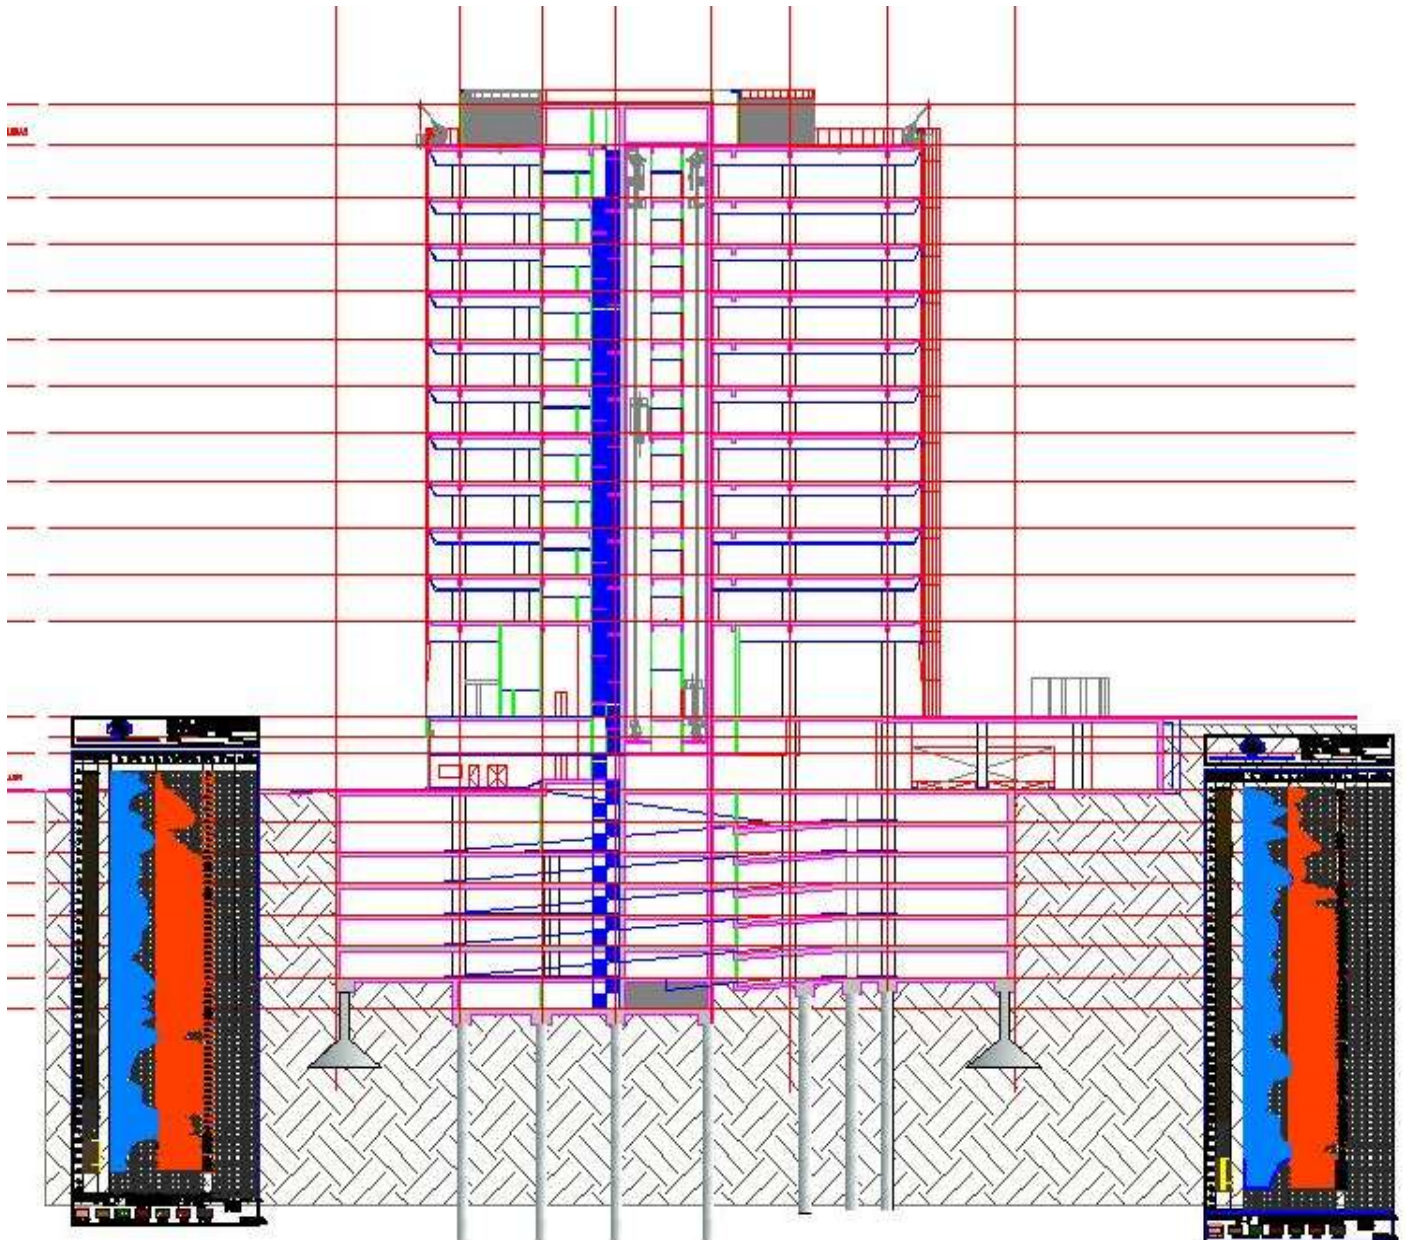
CORTE ESQUEMATICO DEL PROYECTO CON ZAPATAS Y PILAS
